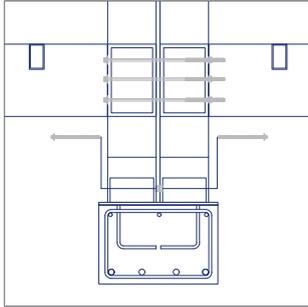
Detalle 1:15 de apoyo de módulos en viga
